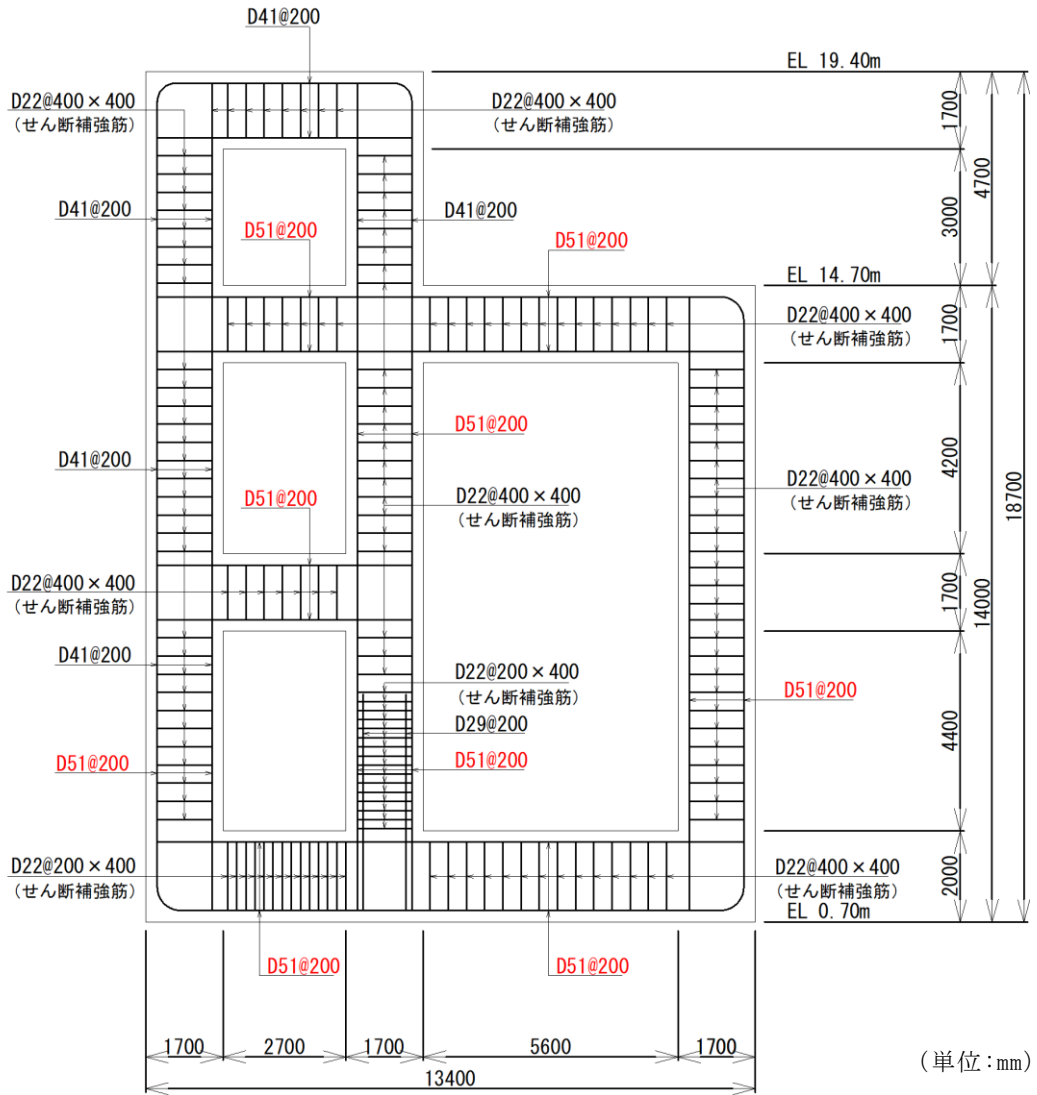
第 1 ベントフィルタ格納槽概略配筋図 (A-A 断面)
